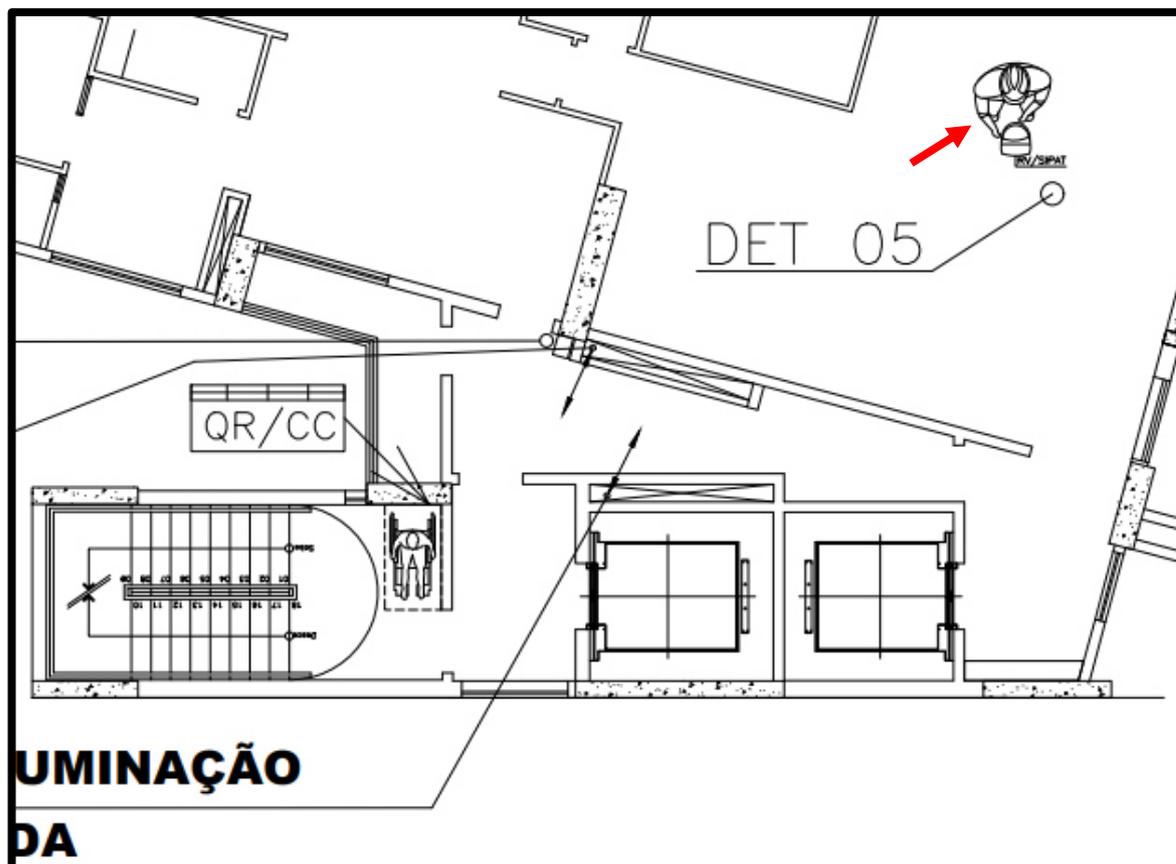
Locação das câmeras para observação da área de armazenamento de materiais e do almoxarifado do subsolo 1 na fase 3 do canteiro
